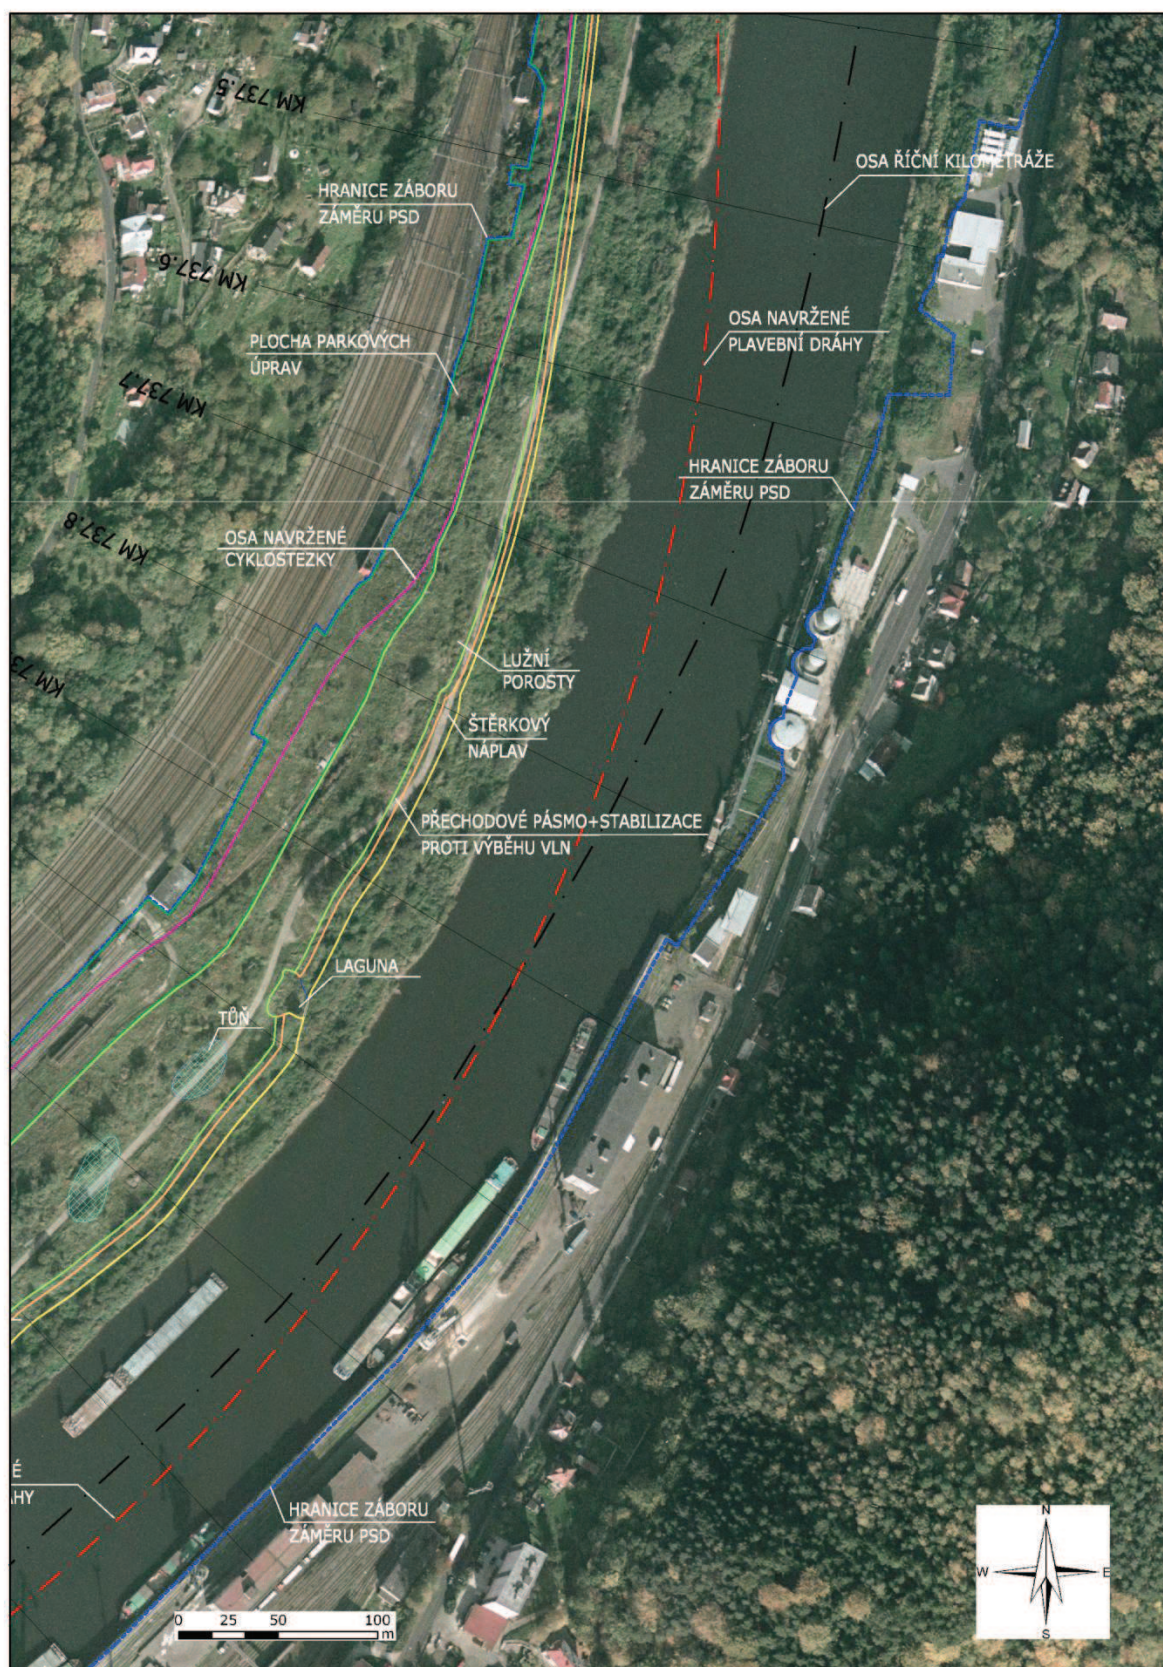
Přehledná situace - Revitalizace nad horní rejdou
